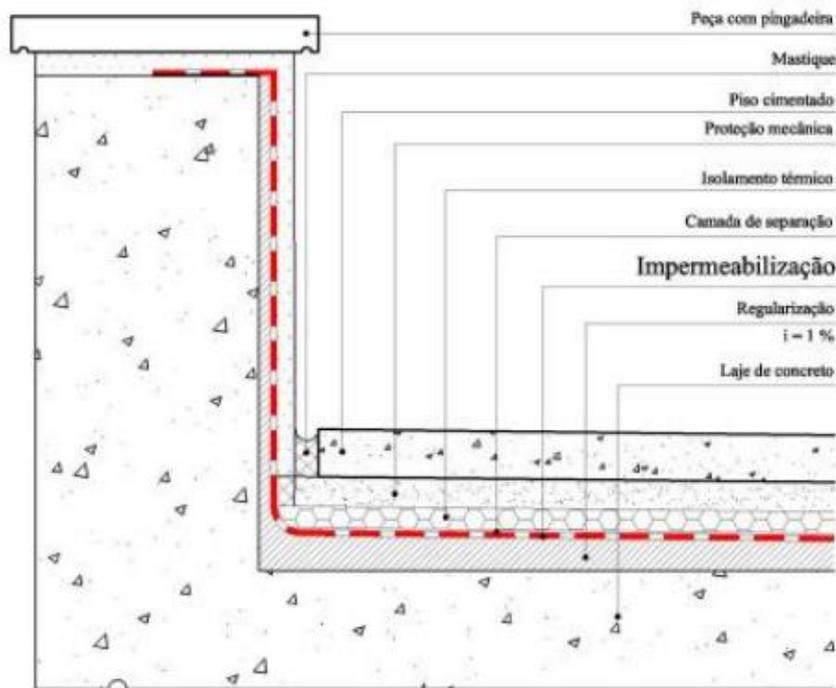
Detalhamento da impermeabilização pingadeira (CRUZ, 2003).
